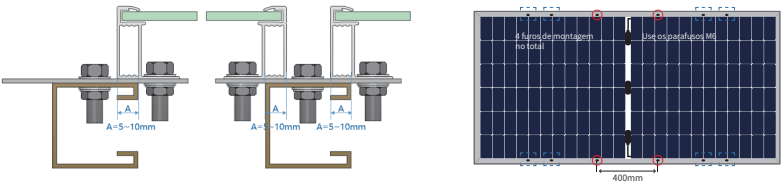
Diagrama de instalação do furo de montagem de componente lado duplo
